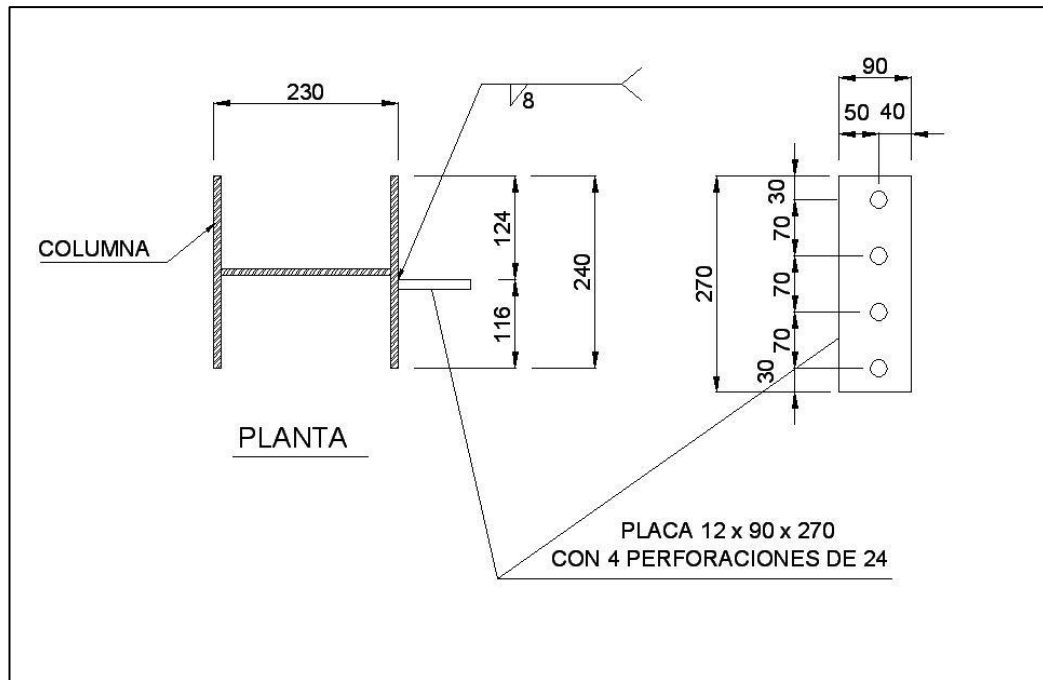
Placa con barrenos y soldadura en una columna
